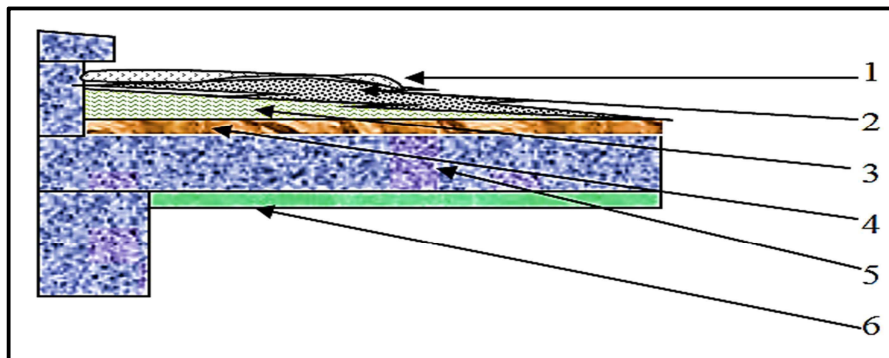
Coupe transversale de Terrasse inaccessible
